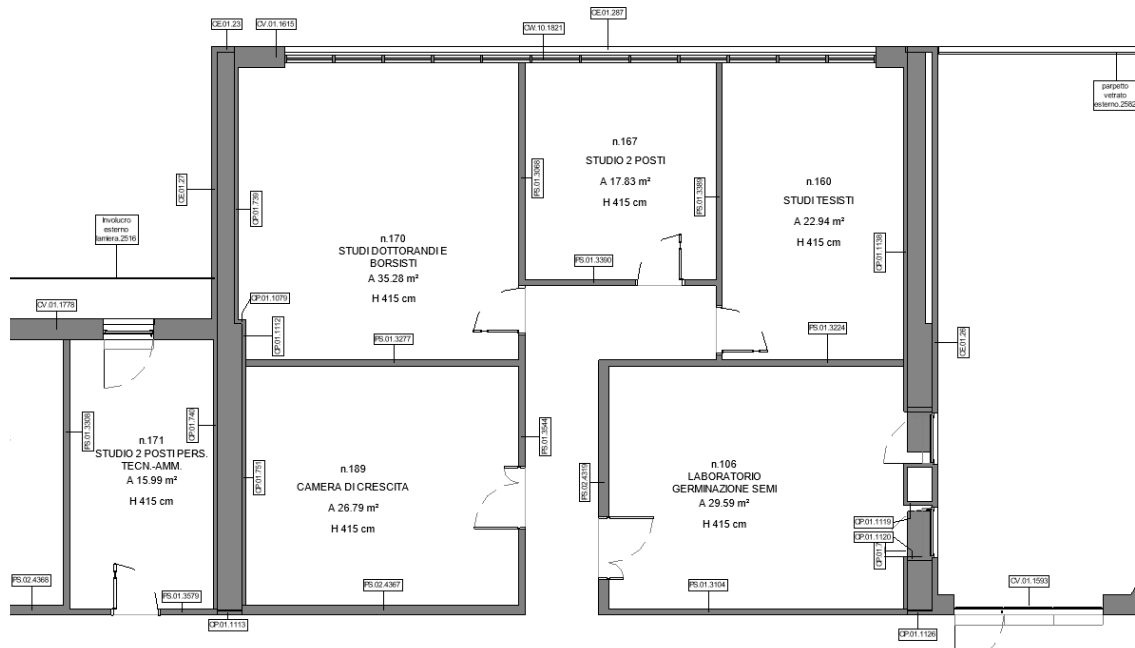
Stralcio pianta piano secondo con etichette muri (Autodesk Revit)
